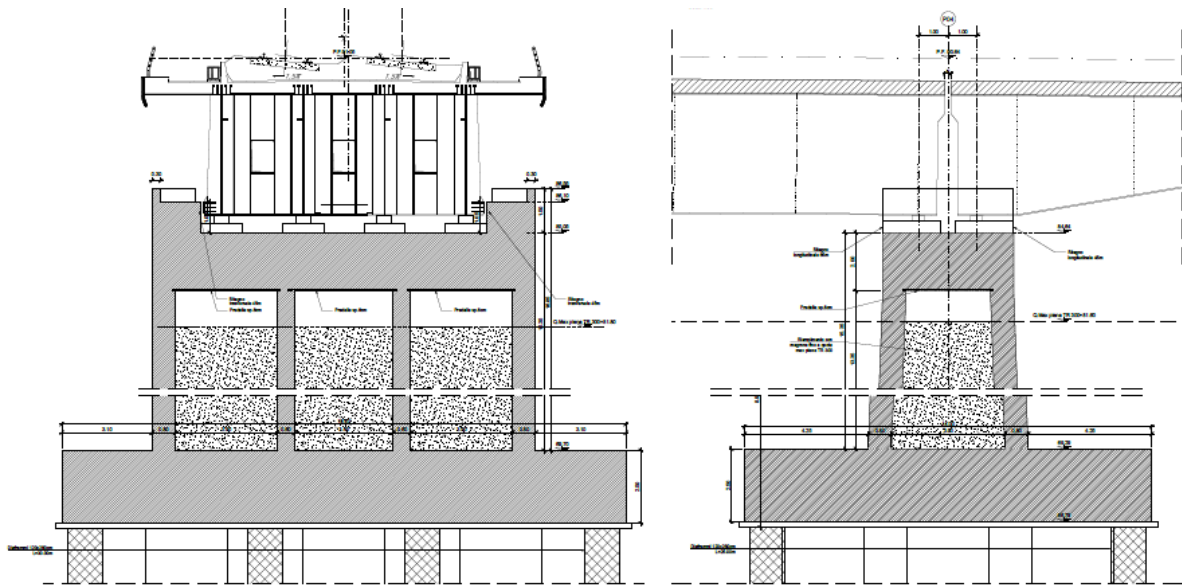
Sezione in direzione trasversale e longitudinale rispetto all'asse del viadotto P4
